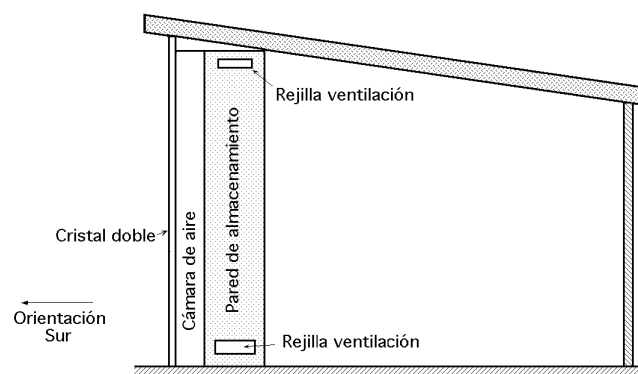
Esquema de una casa con calentamiento del muro Sur por energía solar
